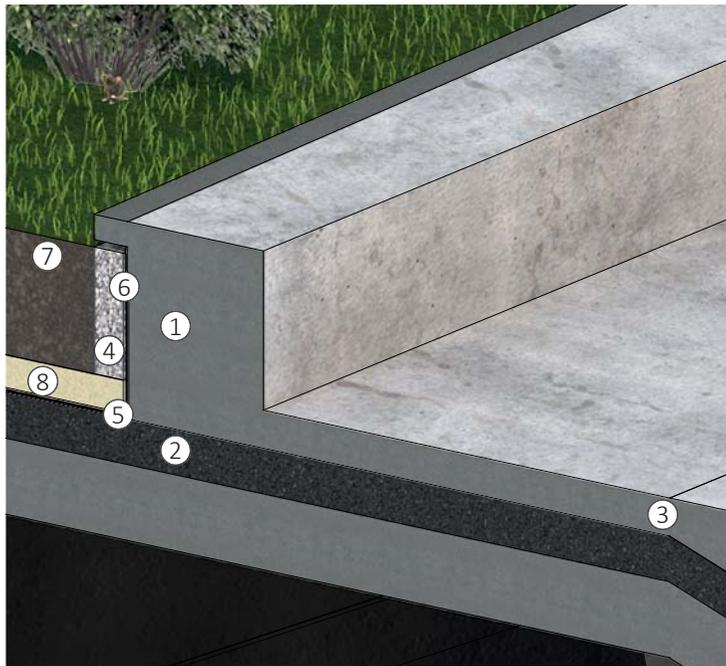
ABSCHLUSS ZU LICHTRAUM INNEN
